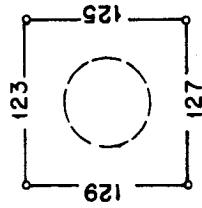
Betonstauchungen, Stahldehnungen P 2
